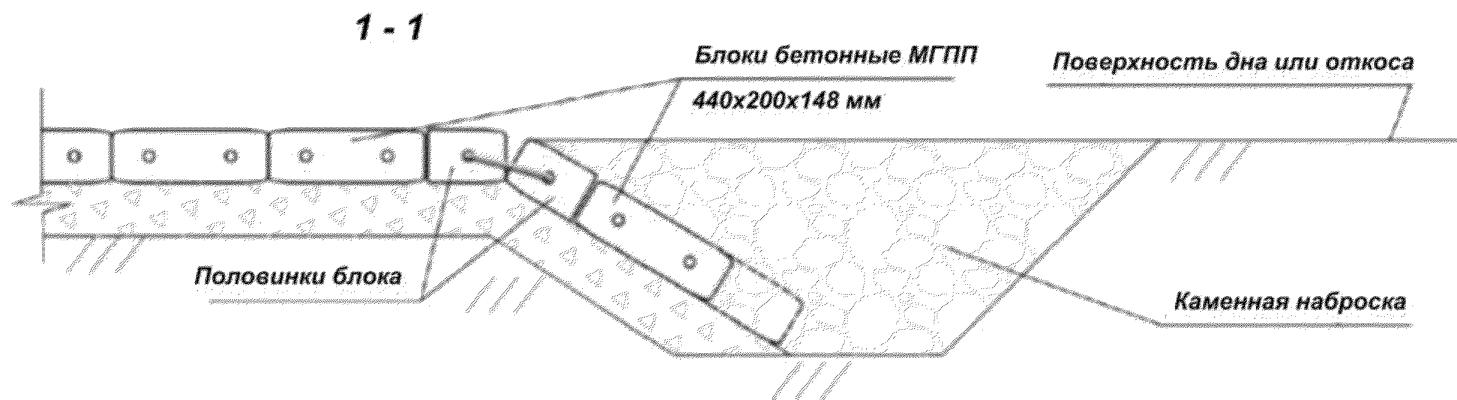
Укрепление откоса, берегоукрепление. Схема укладки блоков МГПП, фрагмент плана
